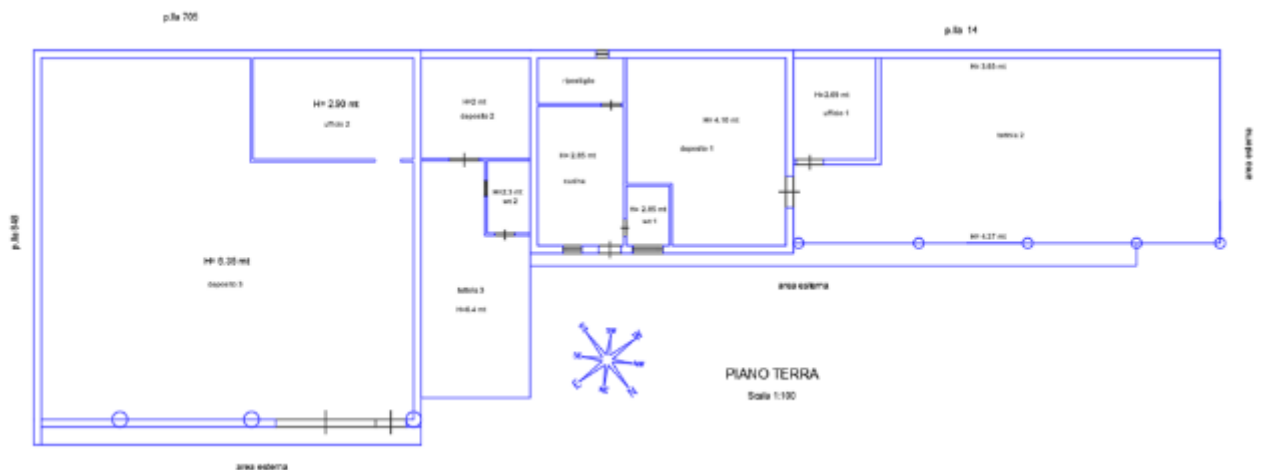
LOTTO 4 - planimetria capannoni e tettoie
